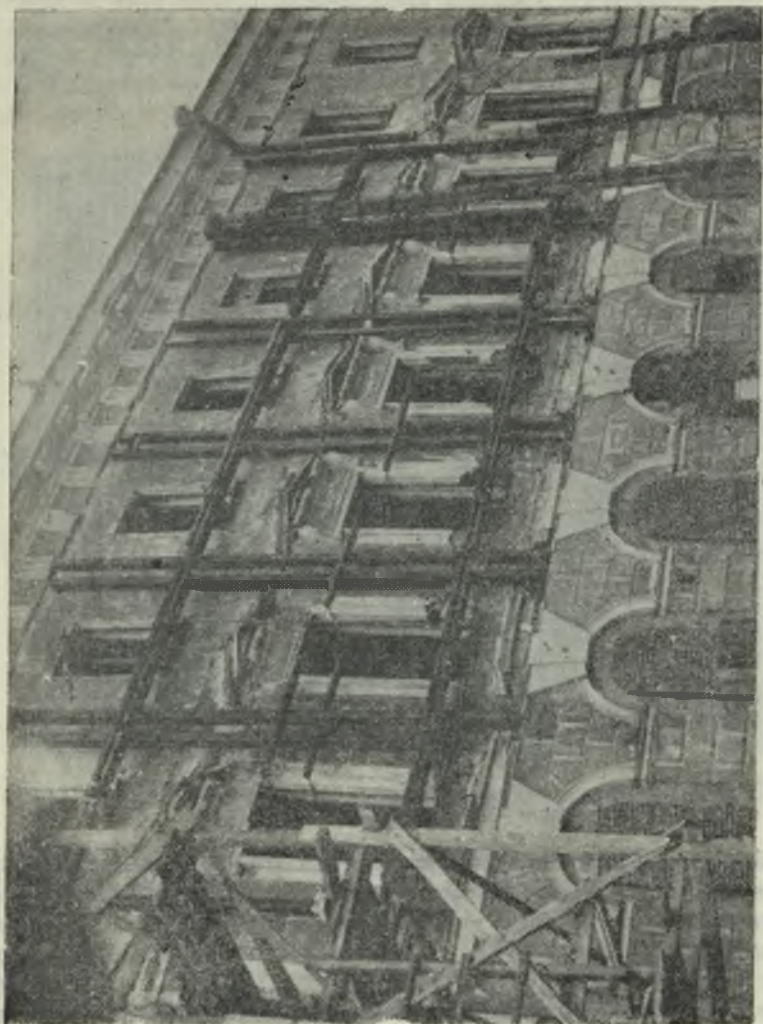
Распределительная рама натяжной системы, смонтированная на аварийном участке фасадной стены здания Ленэнерго.
